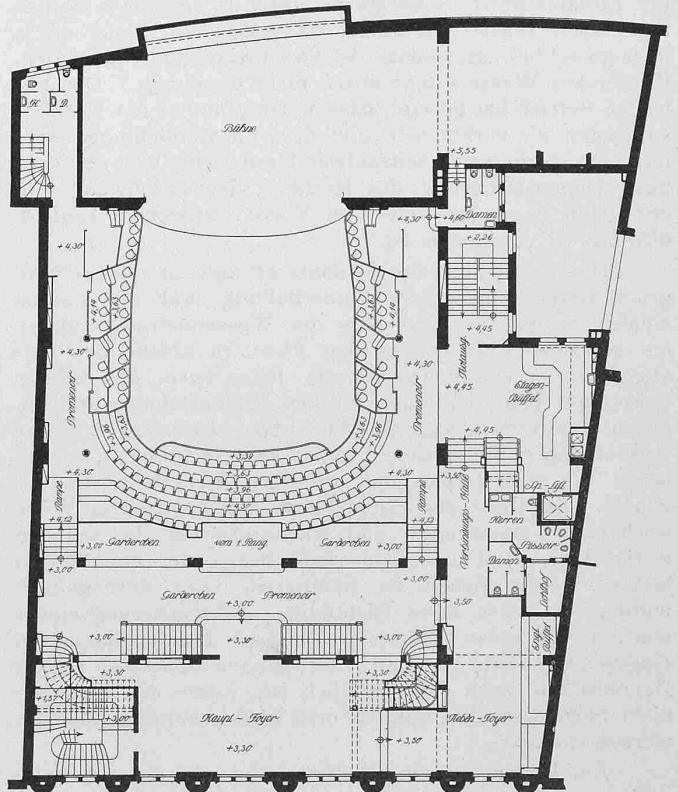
Parterre-Grundriss, 1 : 350.
